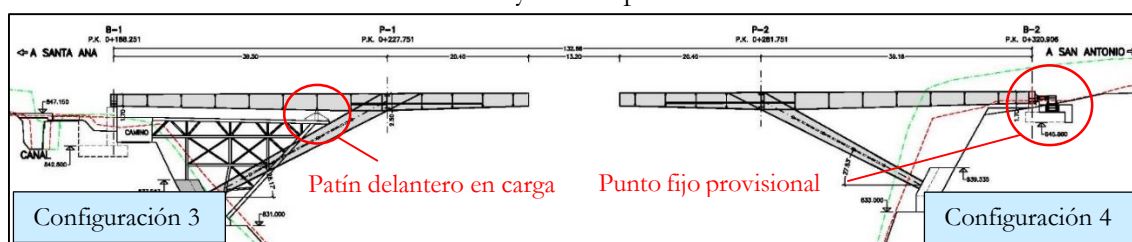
Alzado del puente sobre el río Virilla inmediatamente antes de disponer la dovela de cierre central
